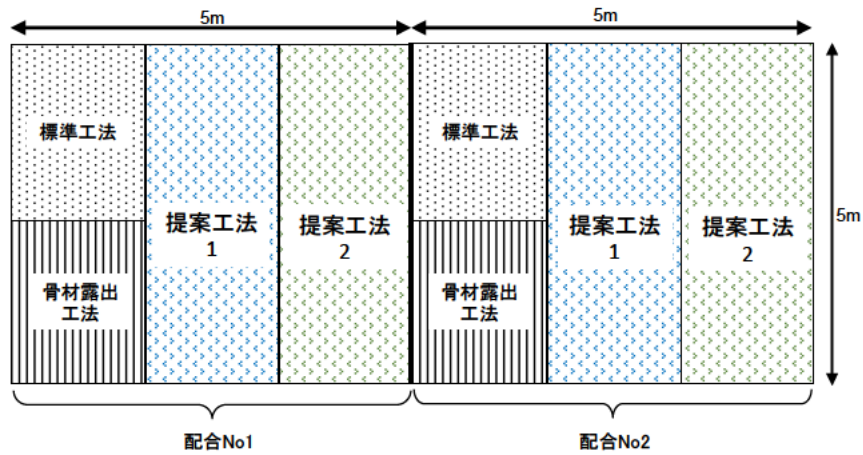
粗面仕上げ方法の種類と区割り（平面図）
